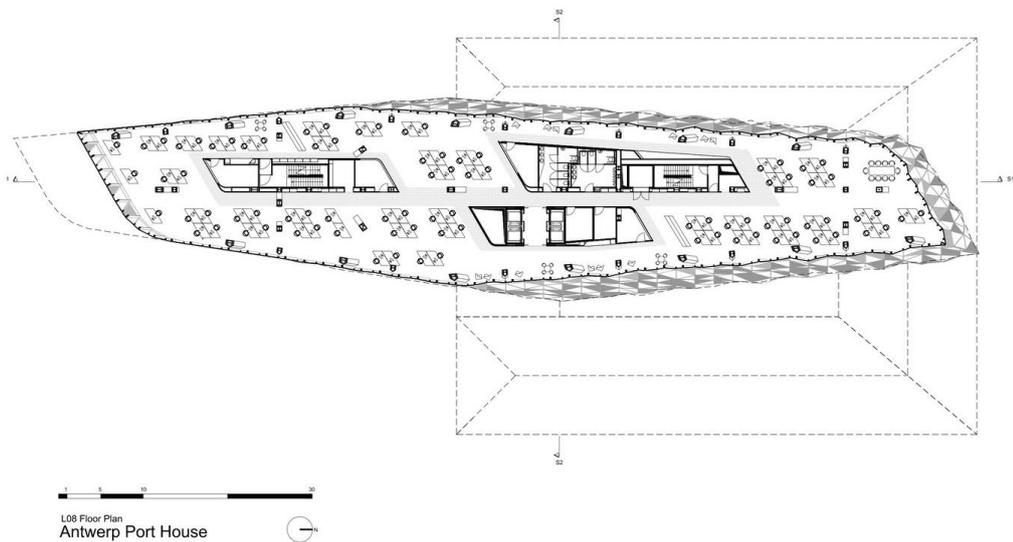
Plano Planta de Coworking y áreas de reuniones Oficinas portuarias de Amberes,
